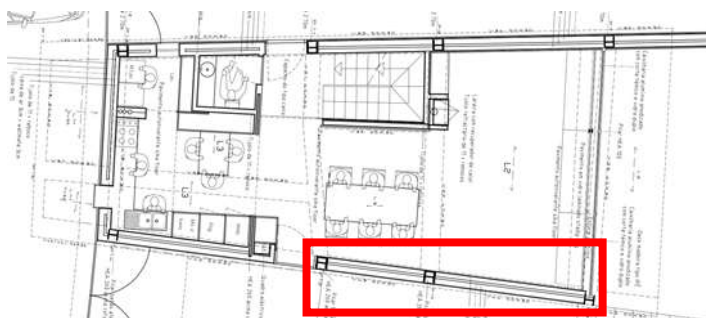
Localização da parede na planta arquitetónica do primeiro piso.
